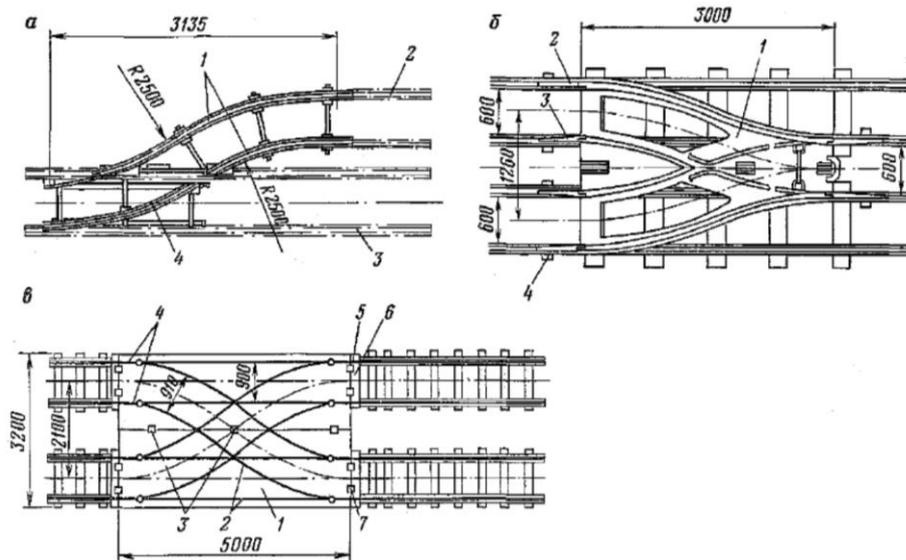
Обменные устройства для вагонеток: а – накладная стрелка; б – накладная плита-разминовка; в – накладная двухсторонняя плита-разминовка
